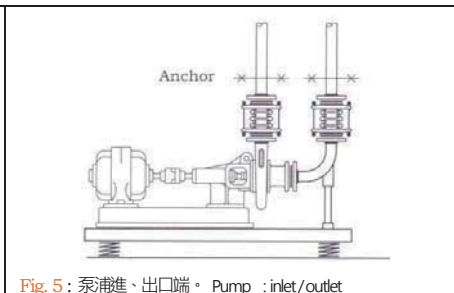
泵浦進、出口端。 Pump : inlet/outlet
